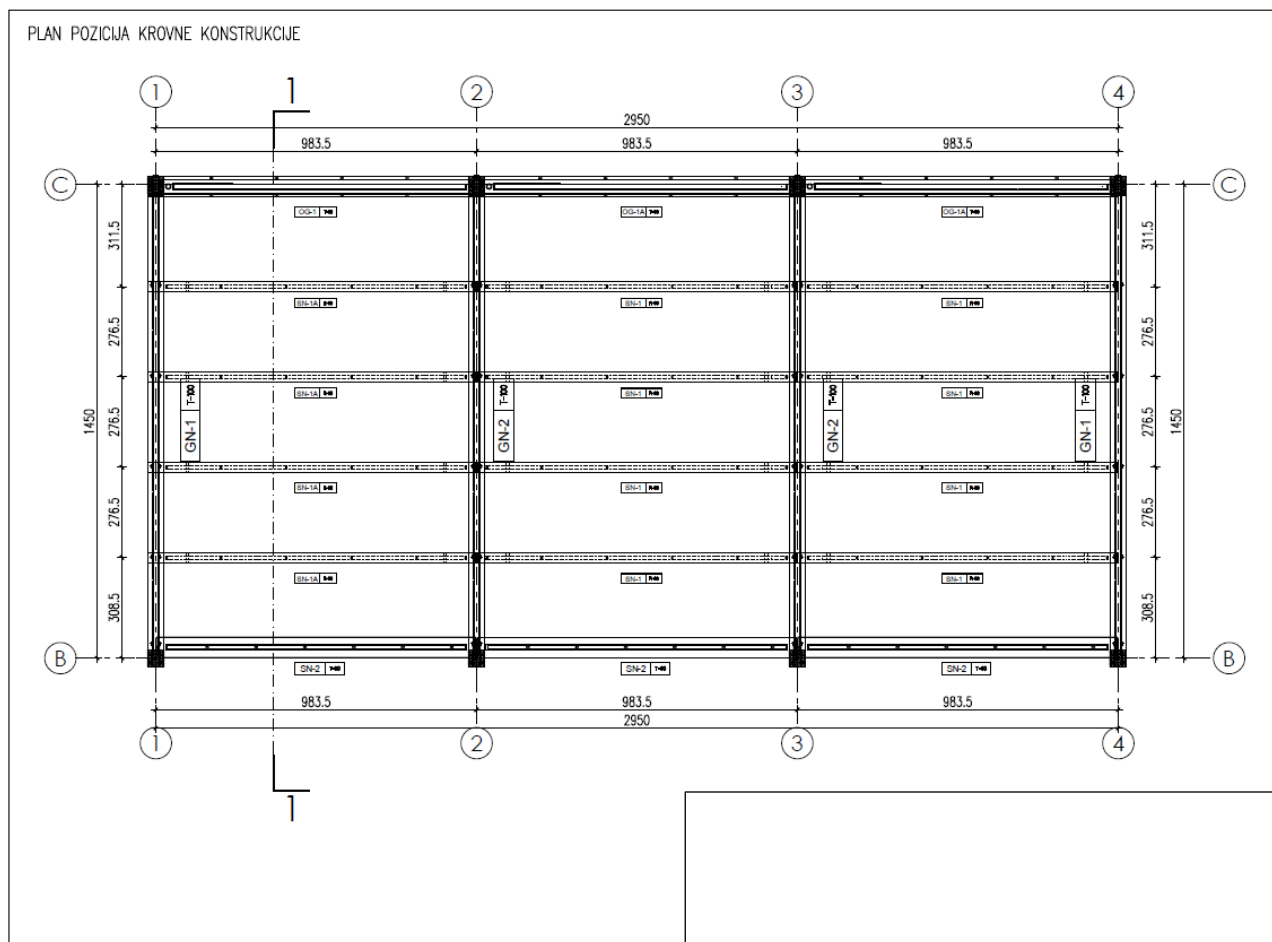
Plan pozicija faza, izvor: Tehnička dokumentacija projekta
